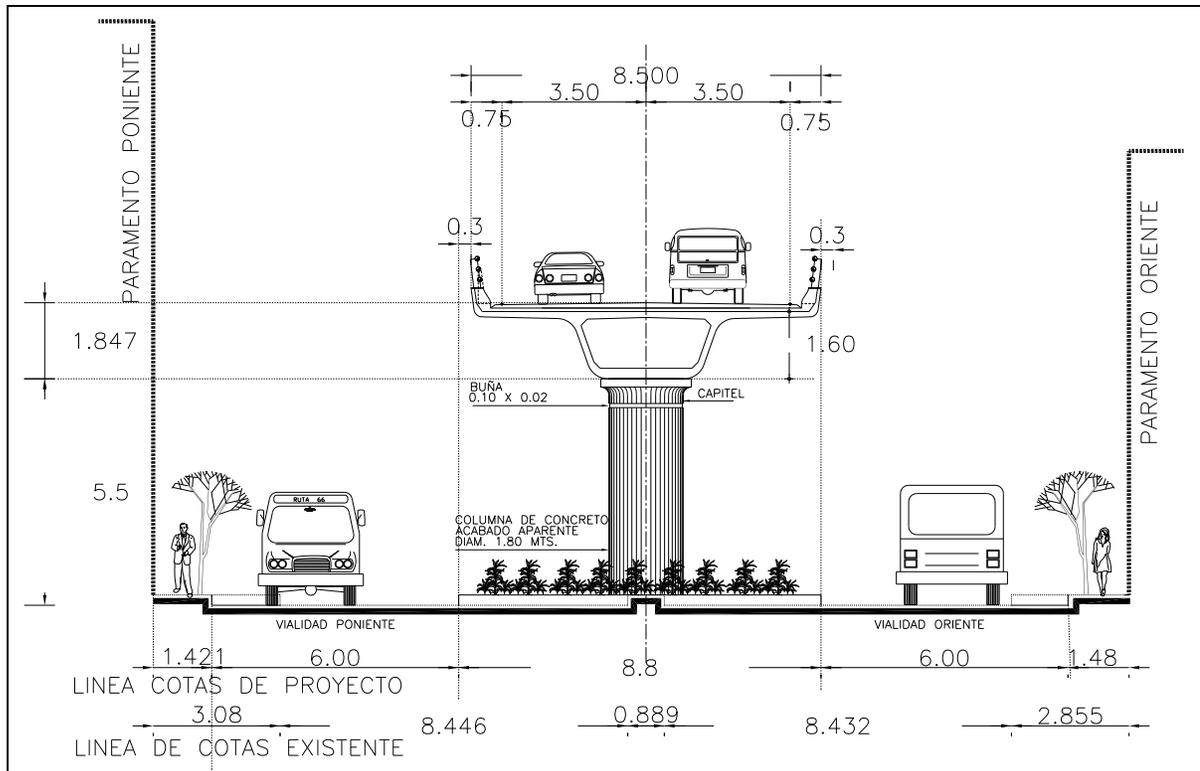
Corte 2-2'. Elevación de la Av Plan de Muyuguarda dirección Cafetales. Acotaciones en m.
